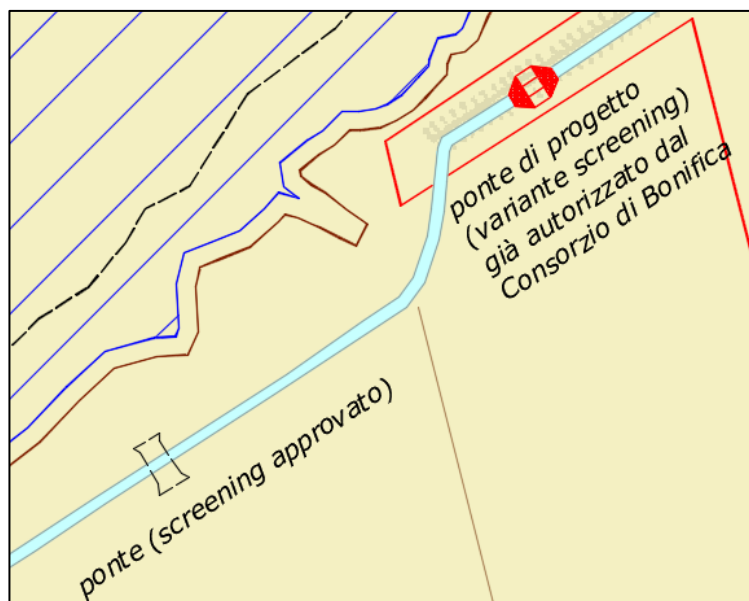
SPOSTAMENTO E ADEGUAMENTO PONTE ALLA PIENA TR30
